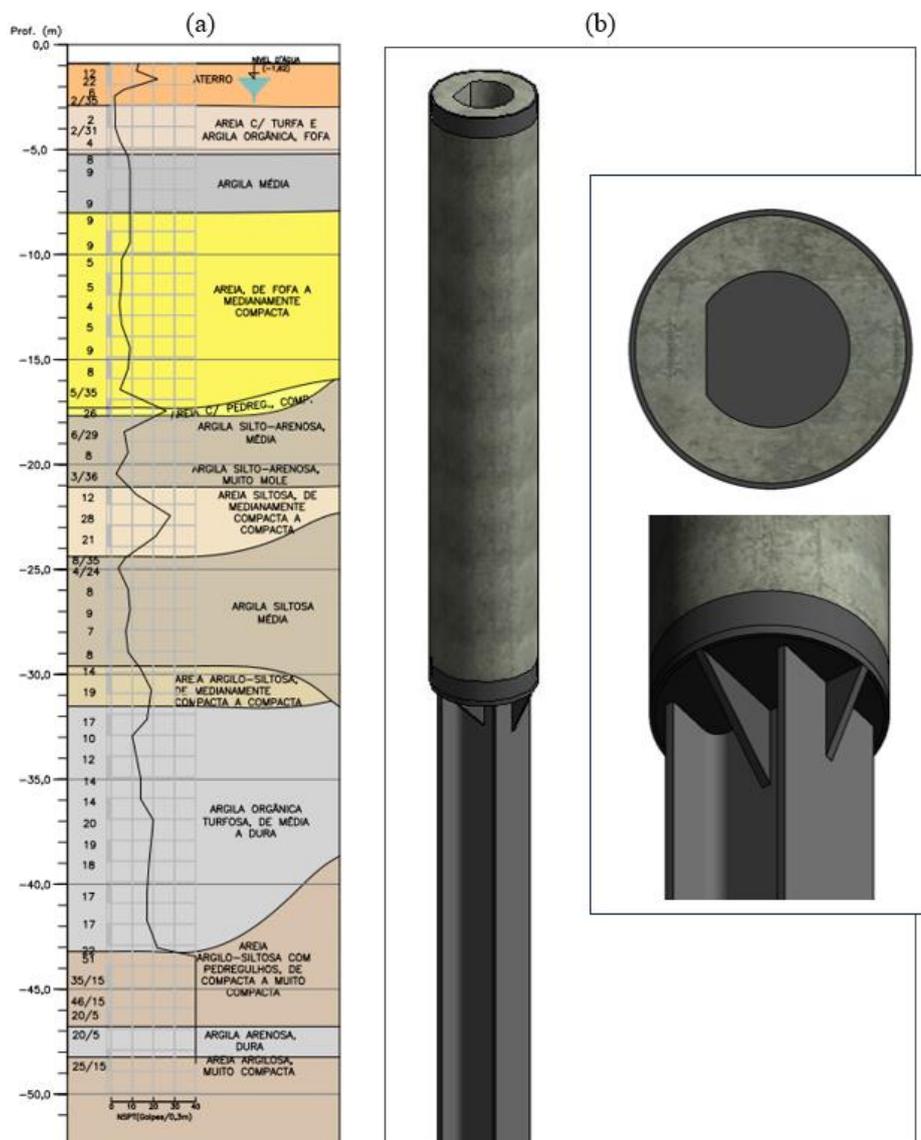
(a) Perfil simplificado. (b) Seção transversal, vista 3D e detalhe da emenda da metálicas com a estaca pré-moldada (sem escala).
